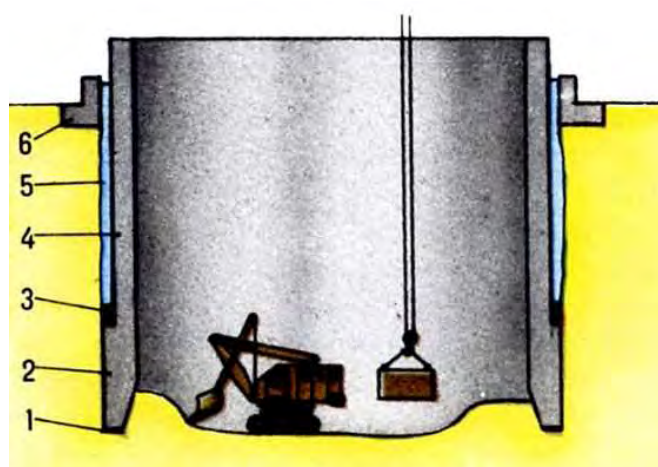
Опускной колодец: 1 — банкетка ножа; 2 — ножевая часть; 3 — замок из плотной глины; 4 — оболочка; 5 — тиксотропный раствор; 6 — форшахта
